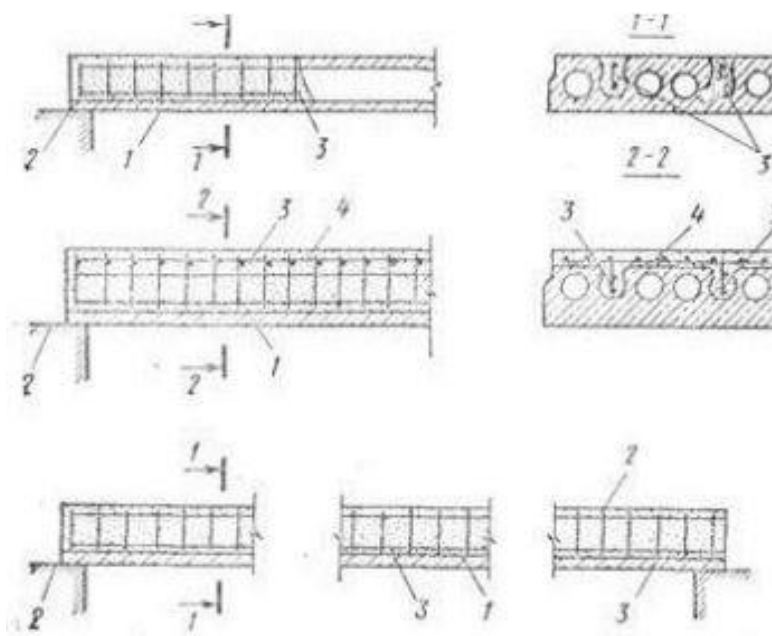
Усиление сборных многопустотных плит перекрытия: 1 — усиливаемая плита; 2 — опора; 3 — дополнительный арматурный каркас; 4 — бетон усиления
